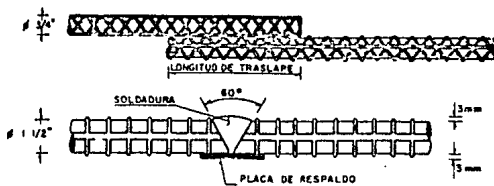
Detalle de traslape y soldadura de varillas
